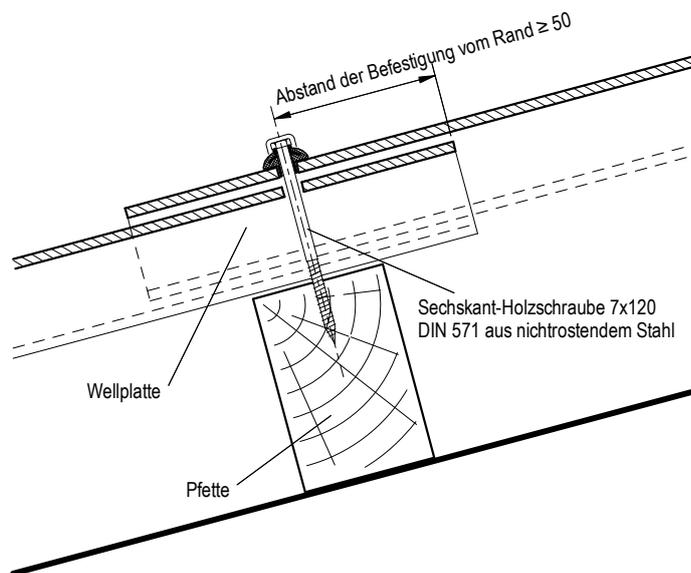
Anordnung der Befestigungen bei Holzpfetten
